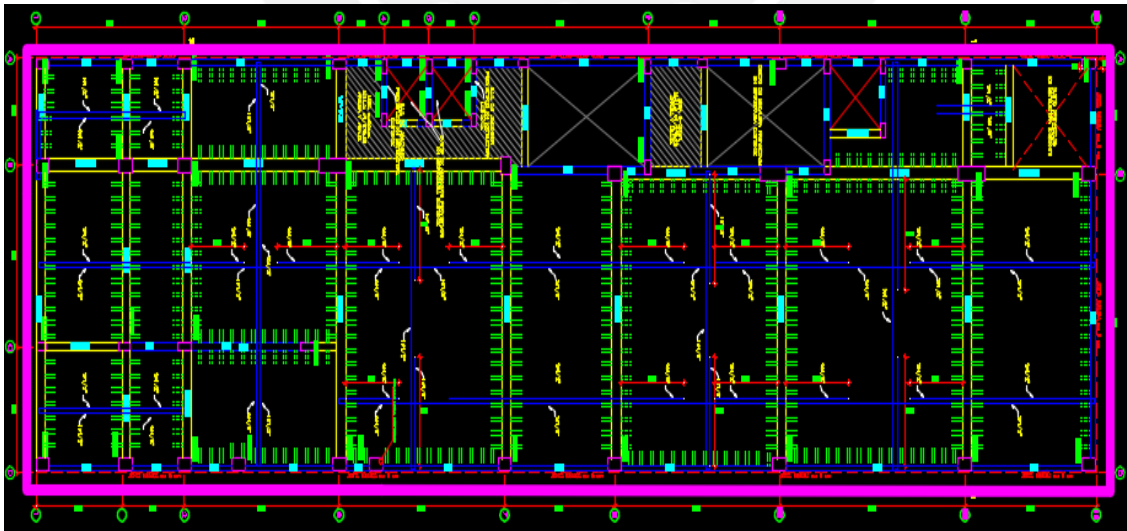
Sector en color magenta para análisis de elementos estructurales (Fuente Galusa sac)
